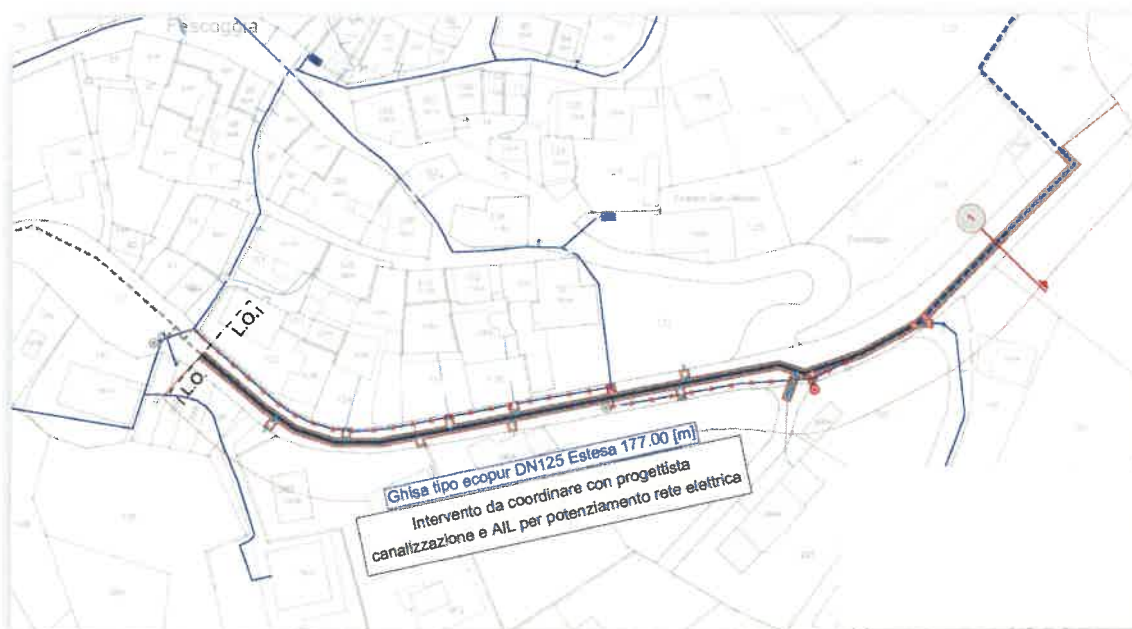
intervento 4, stralcio planimetrico condotta su strada
